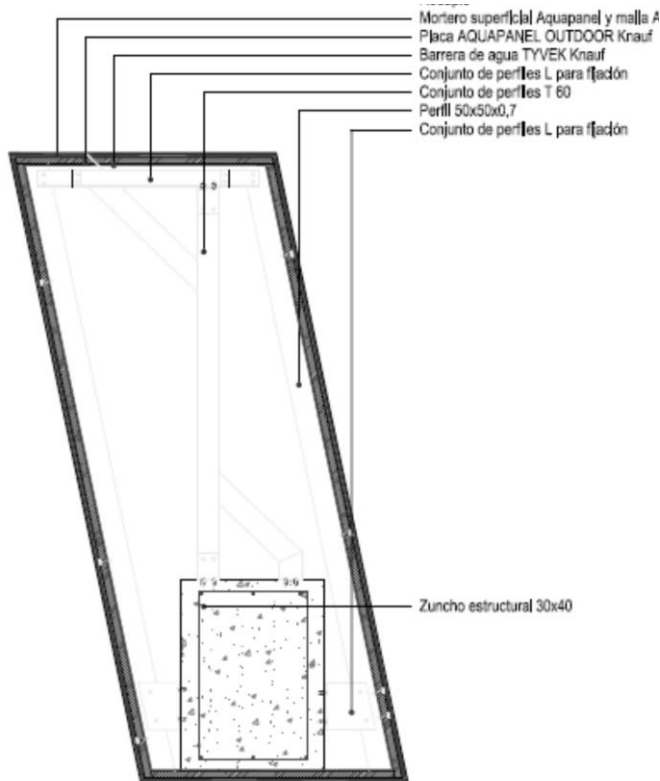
Sección Constructiva del proyecto con el sistema de fachada.
